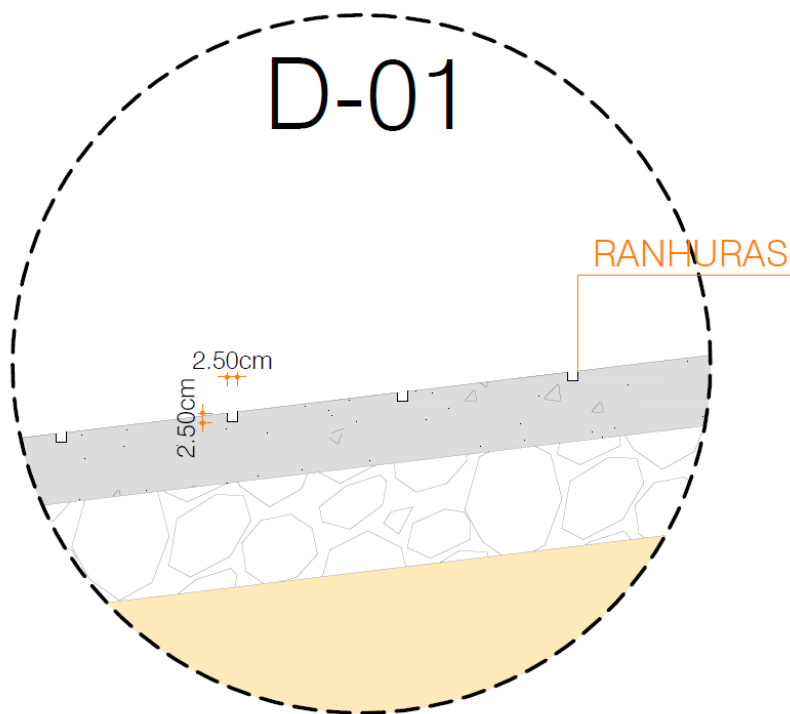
Detalhe das ranhuras da rampa náutica de concreto
